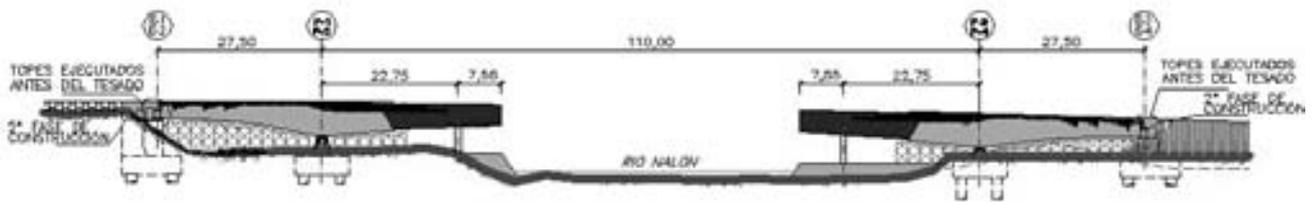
Ejecución de segunda fase de estribos con apoyos inversos, y pretensado del vano lateral cosiendo la junta con la estructura metálica.
